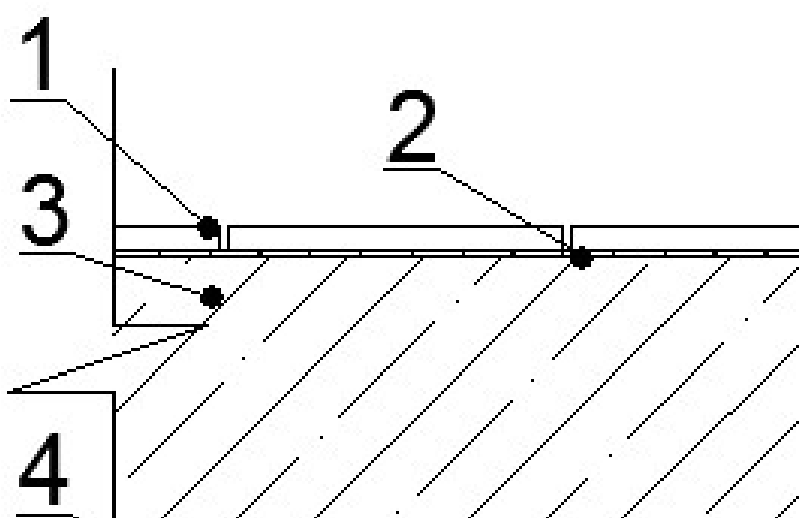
Разрез перекрытия между подвалом и первым этажом.
